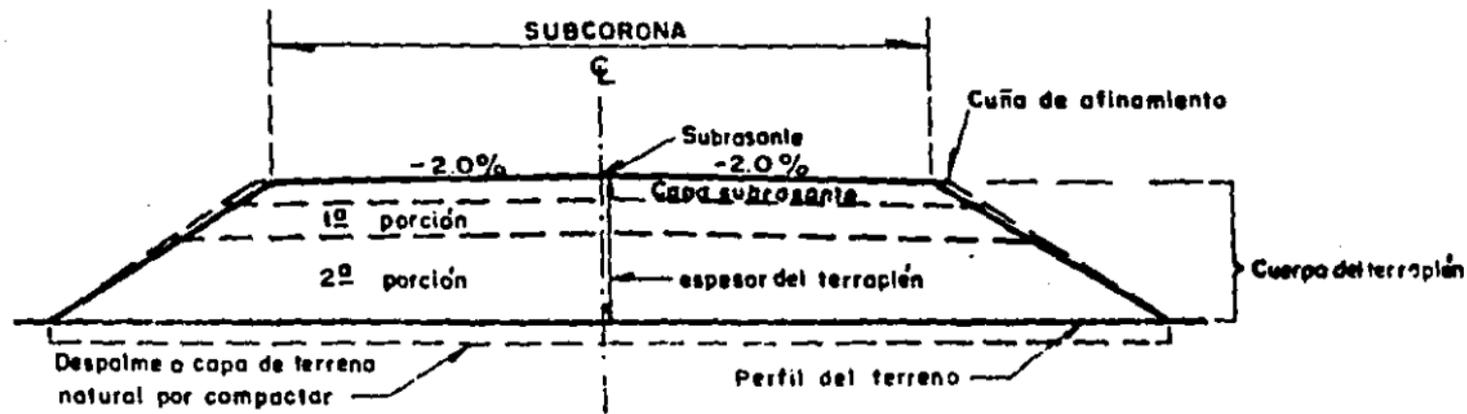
SECCION DE CONSTRUCCION DE UN TERRAPLEN EN TANGENTE
